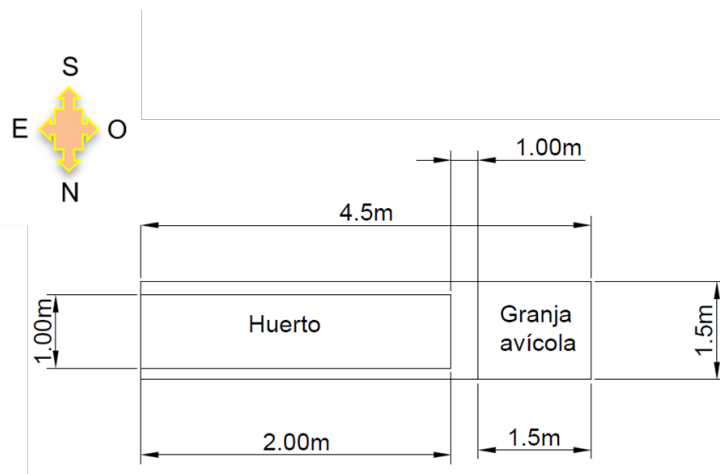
Plano del espacio a utilizar para la construcción de la granja avícola. Fuente propia.
